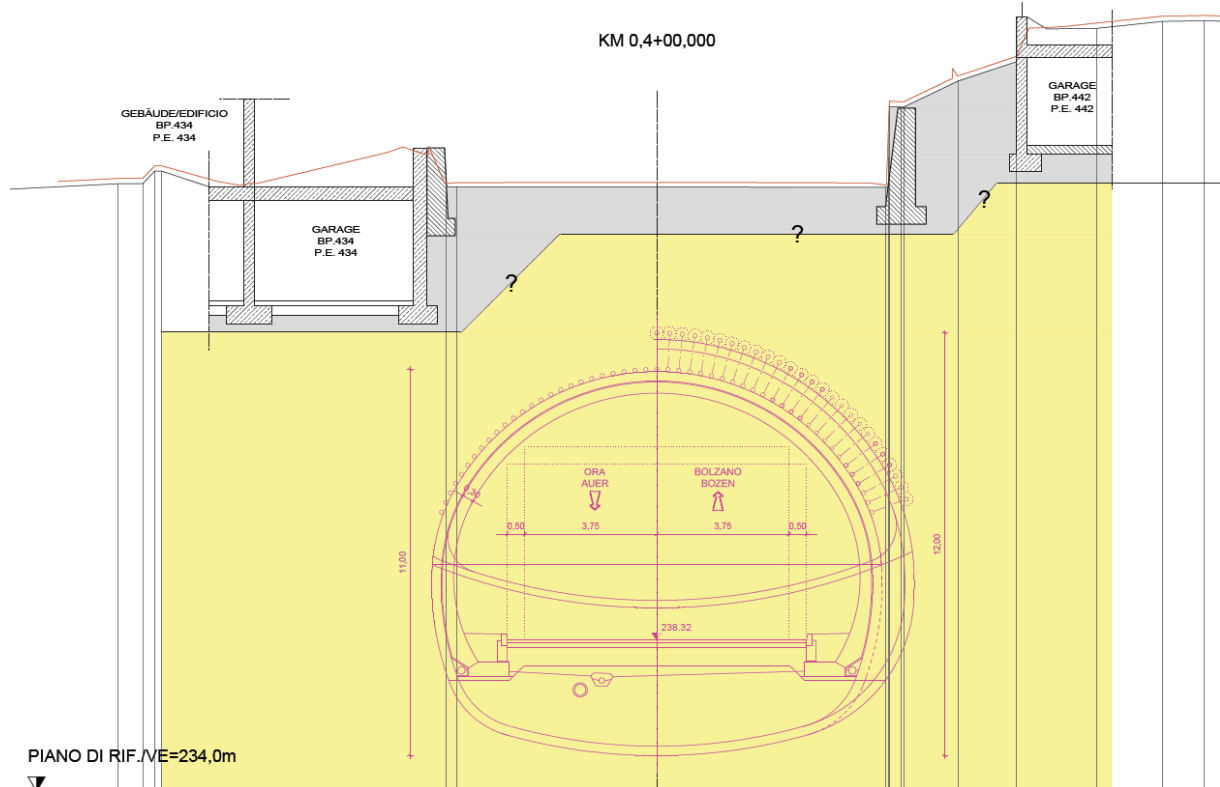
Regelquerschnitt Tunnel in berg. Bauweise mit Rohrschirm
